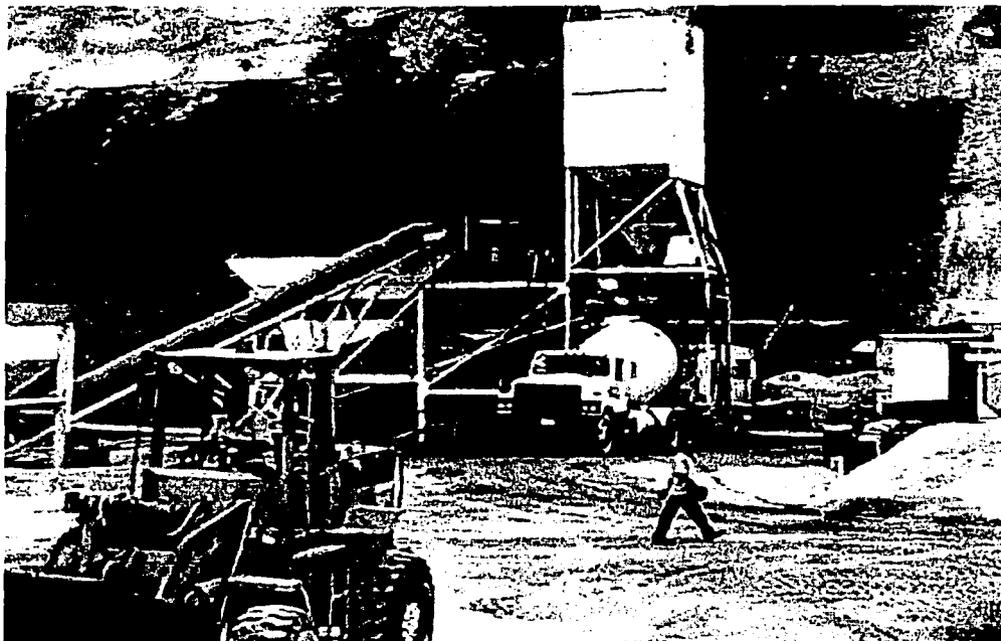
Vista de planta dosificadora de concreto (ODISA 6000)
